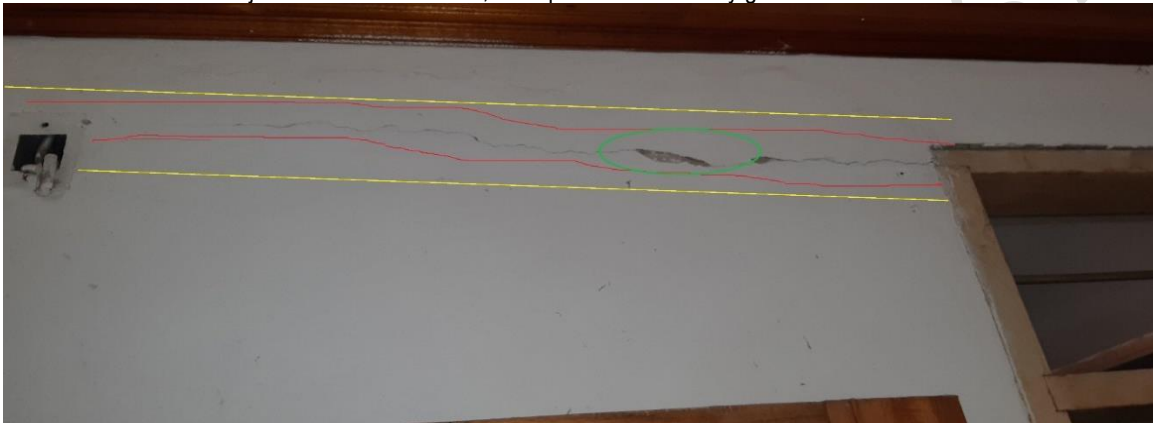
Fisuras y grietas horizontales continuas y progresivas, a una altura de 2.25 mts, plano perpendicular. con desprendimientos de enlucidos y desplazamiento del muro
